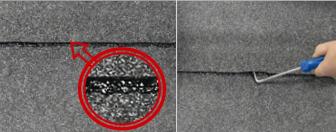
Контроль качества сварных швов кровельного ковра
